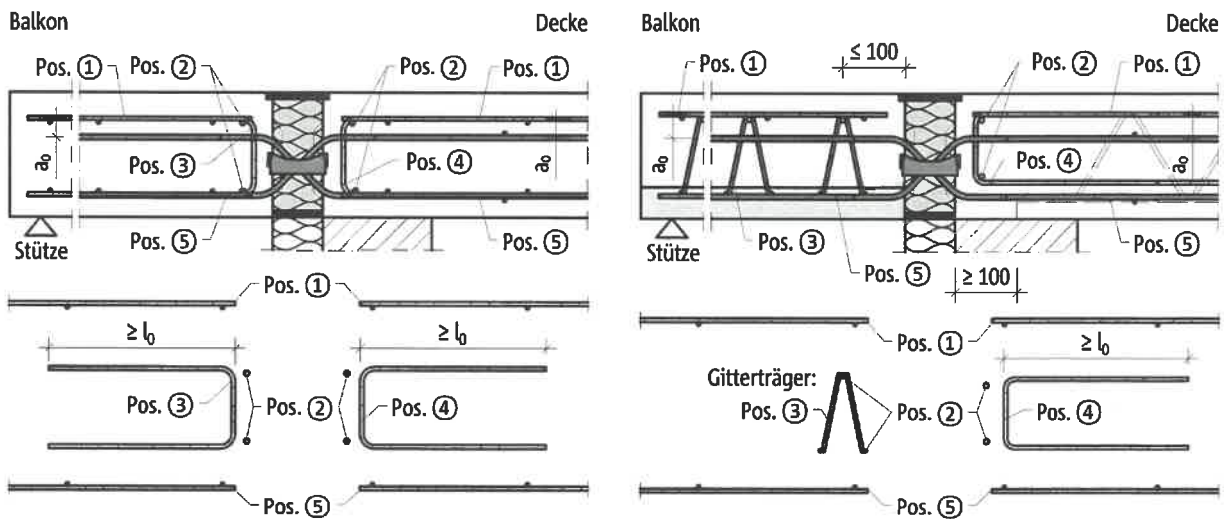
Schöck Isokorb® T Typ Q-VV6 bis -VV12 6.0, direkte Lagerung: Bauseitige Bewehrung bei Ortbetonbauweise (links) und Fertigteilbauweise (rechts) schematisch dargestellt
